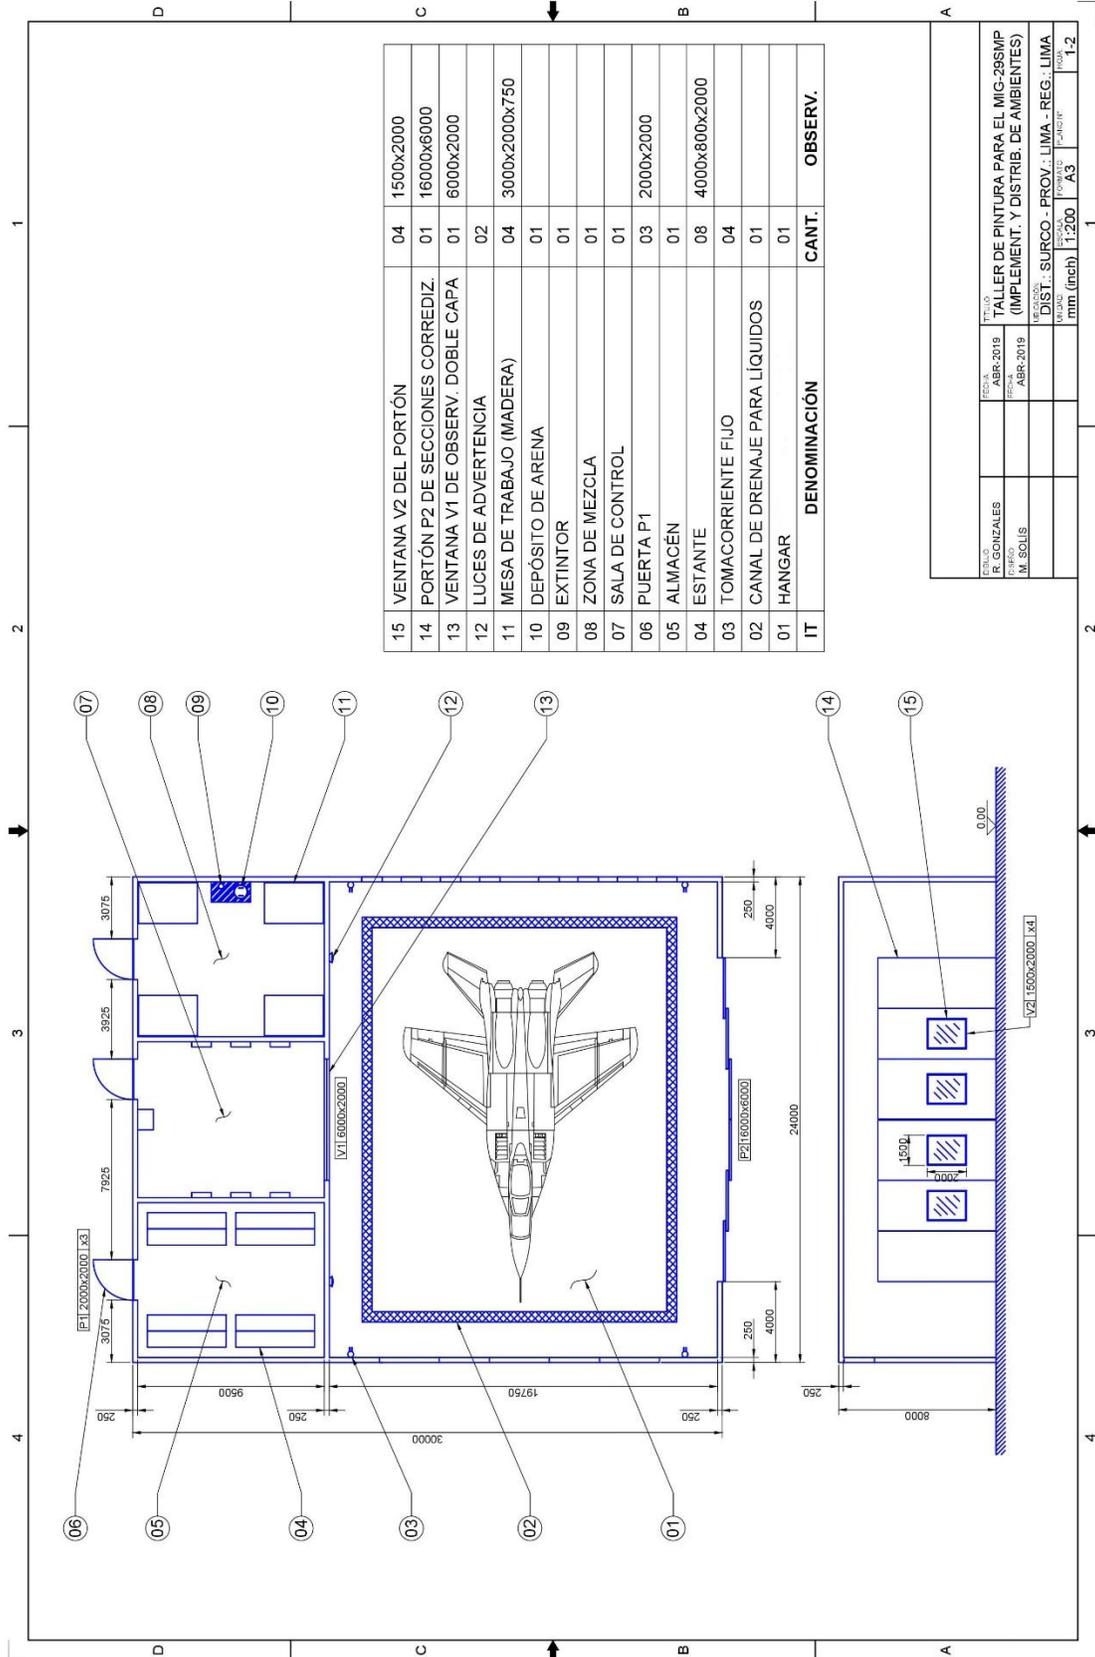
Plano en vista de planta y en vista frontal 1 de 2. Elaboración propia
